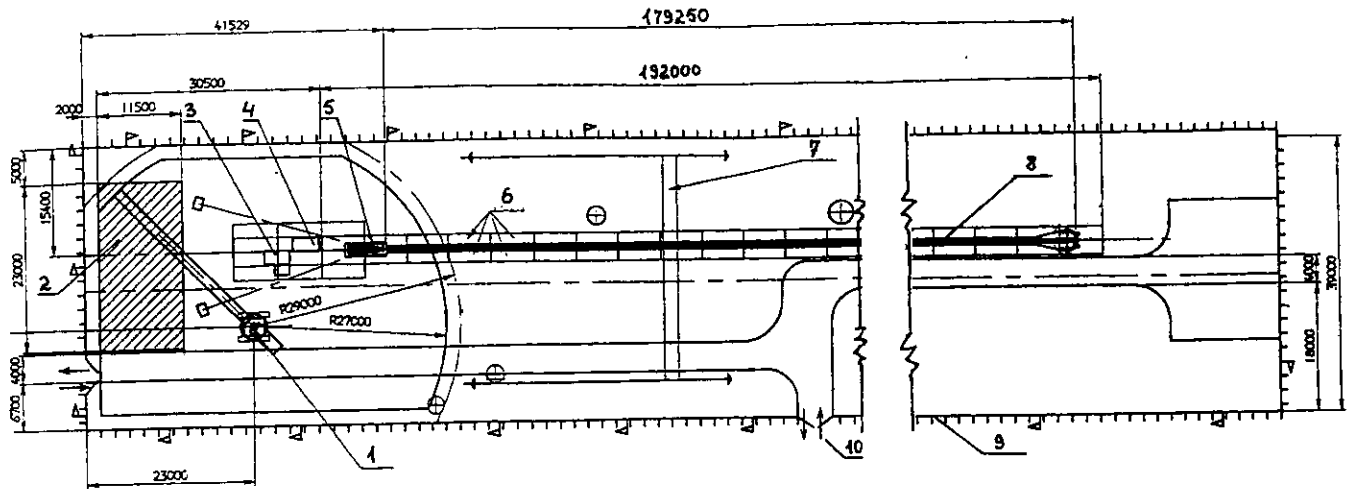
Стройгенплан площадки для предварительной вытяжки арматурных канатов и устройства анкеров
